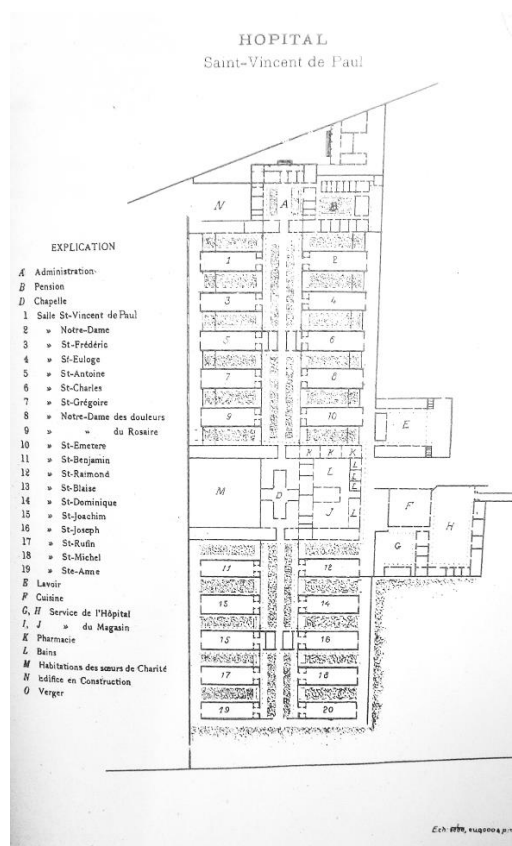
Plano de planta de la distribución pabellonaria del Hospital San Vicente de Paul.⁴⁵
